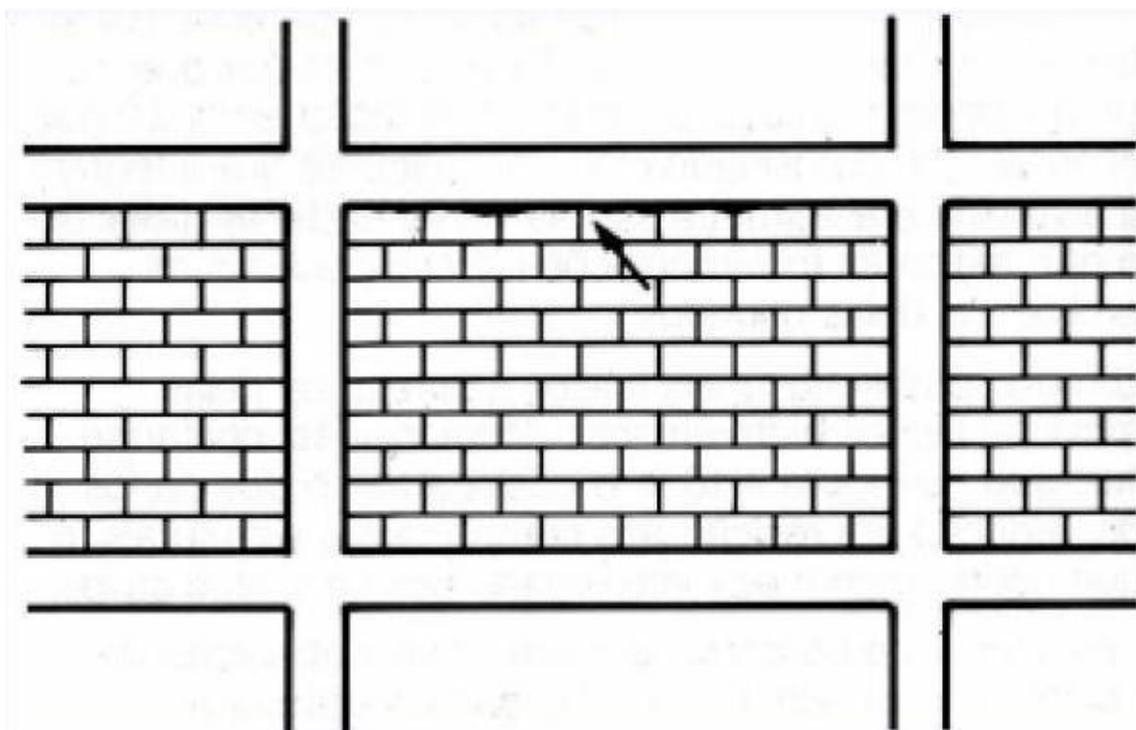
Destacamento da alvenaria junto a estrutura causado por retração da parede e encunhamento precoce
